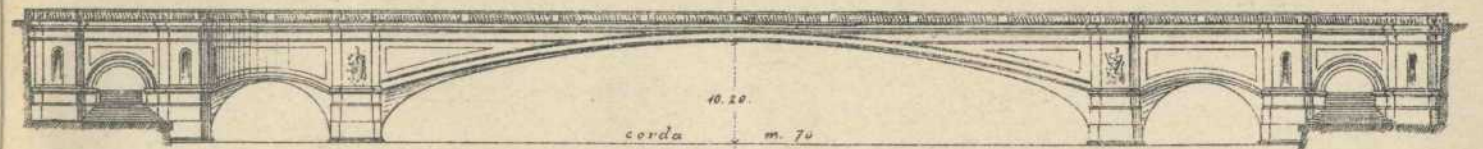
Progetto di ponte in muratura dell'Ing. Ferria.
